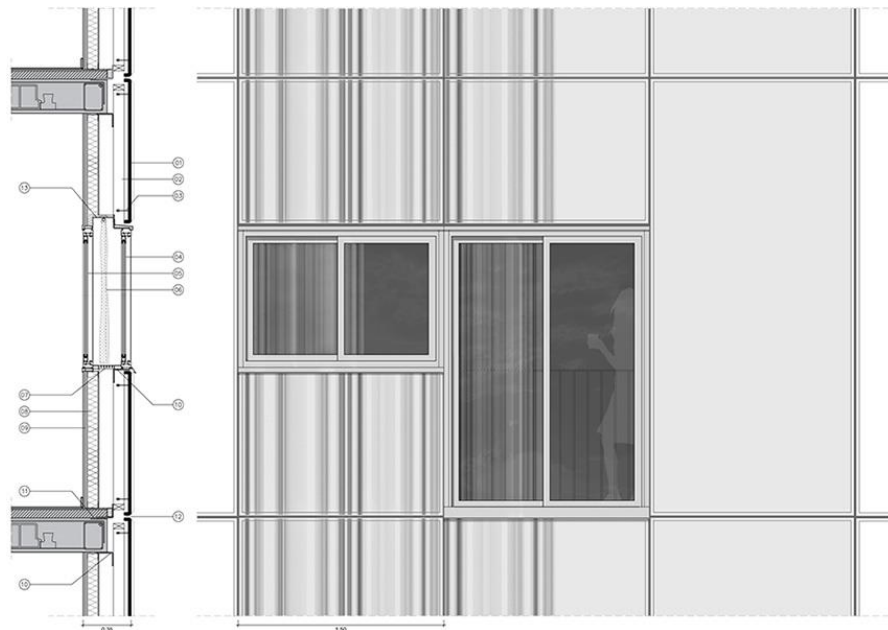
Detalle constructivo de la aplicación de paneles GRC en fachadas ventiladas
